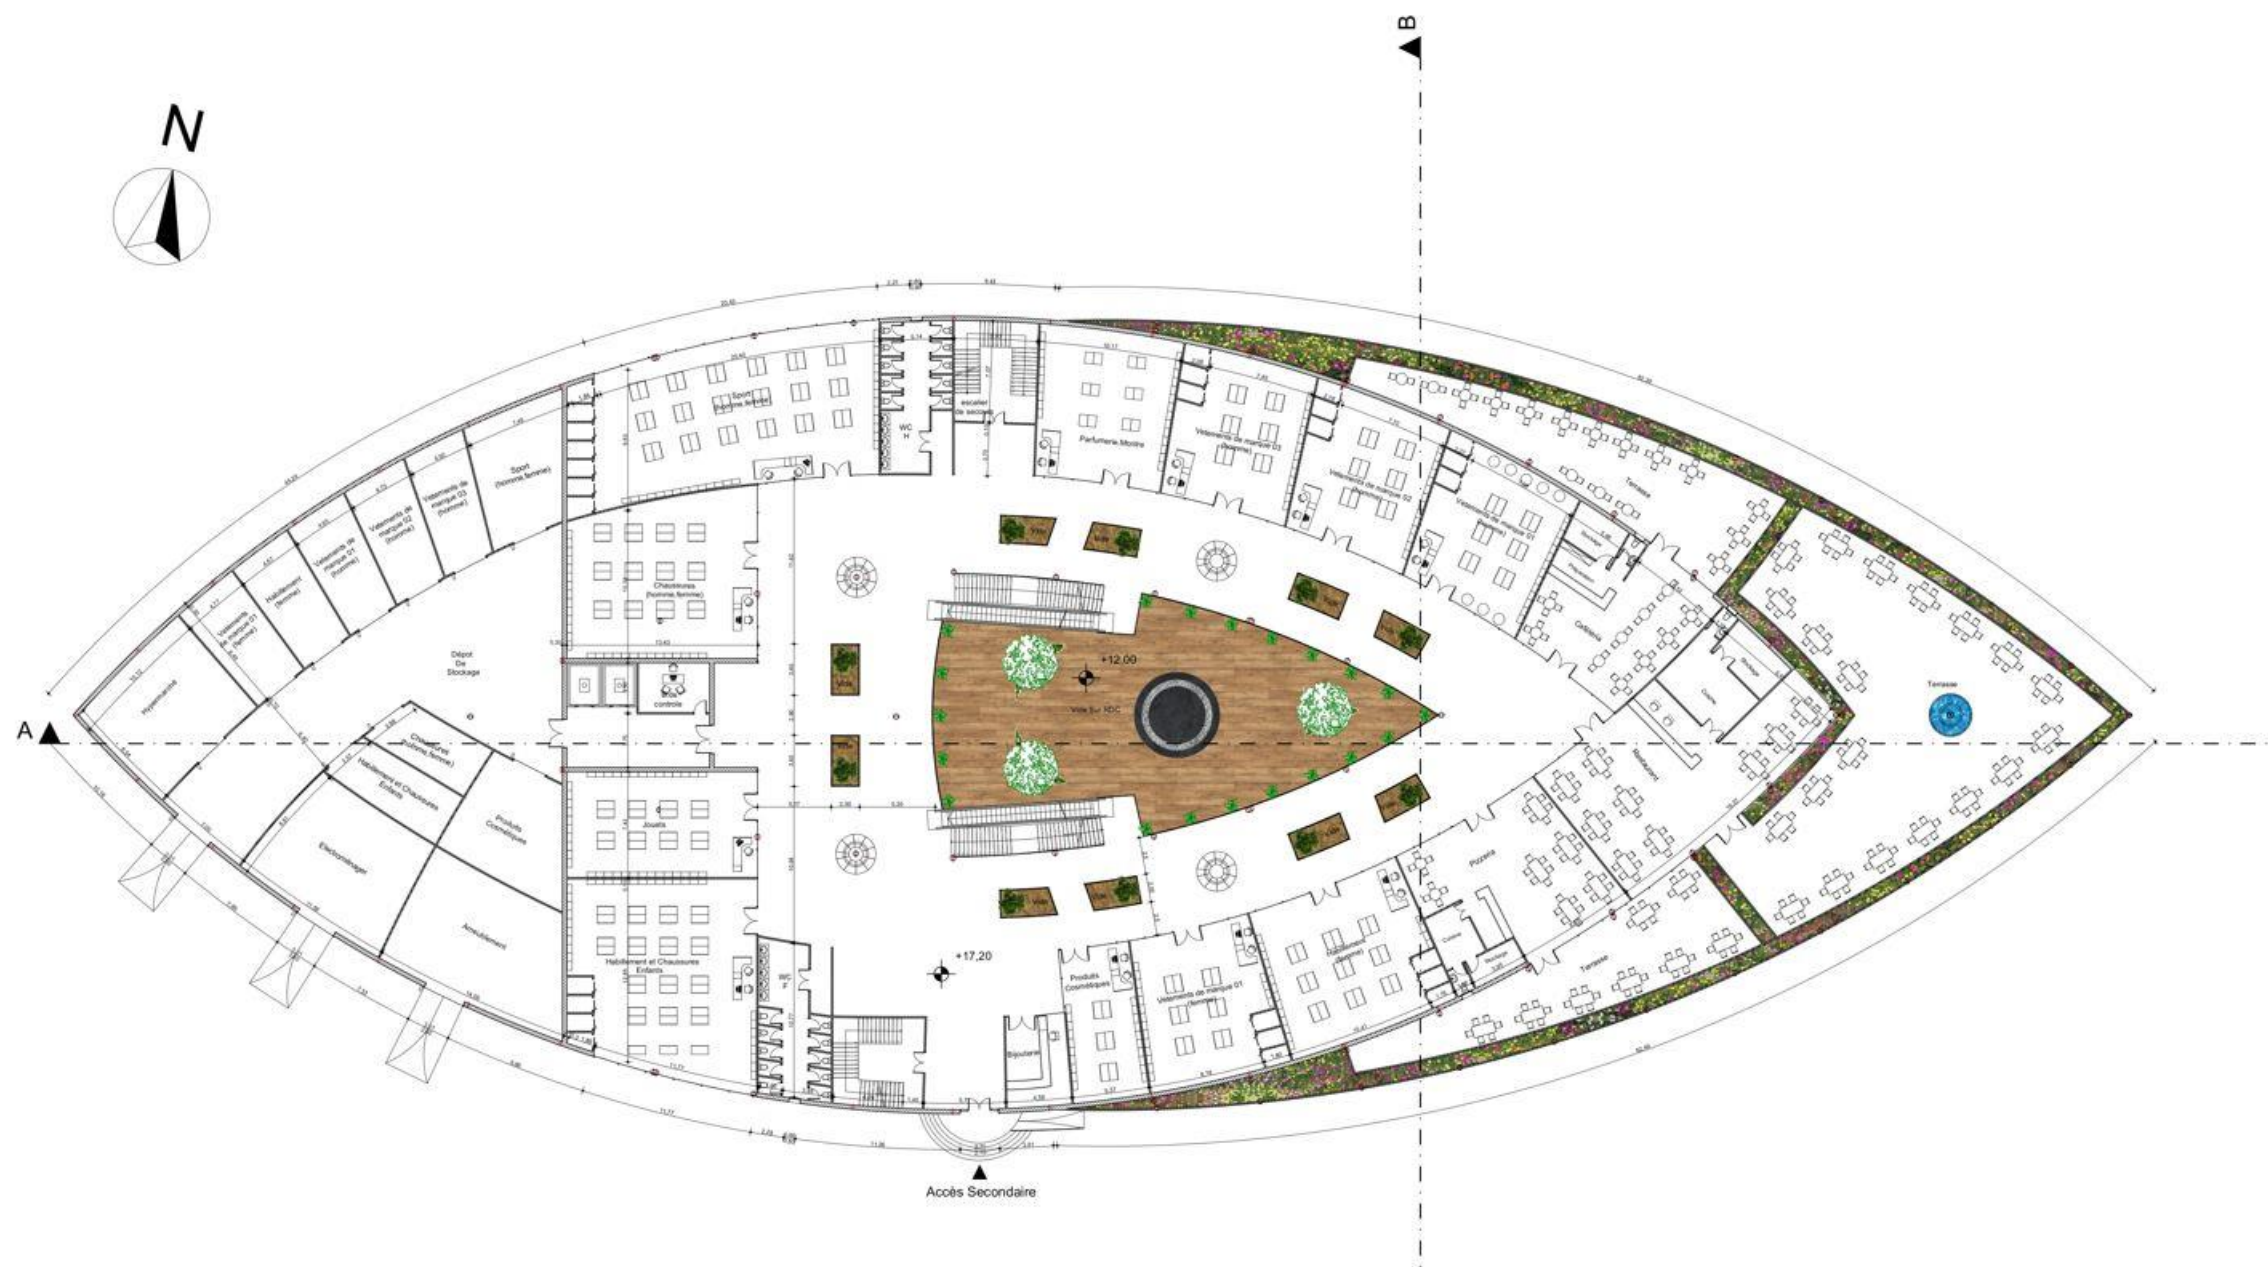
plan 1<sup>er</sup> étage / source : par l'auteur
